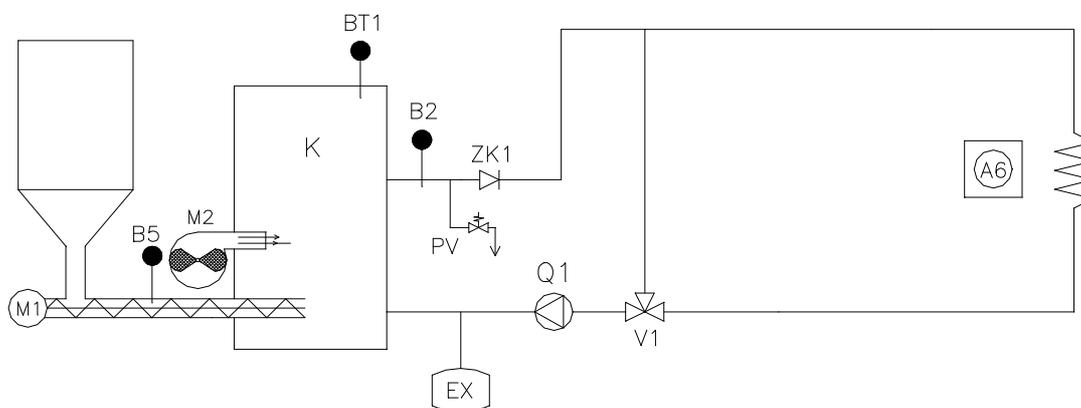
Гидравлическая схема без нагрева теплой воды
